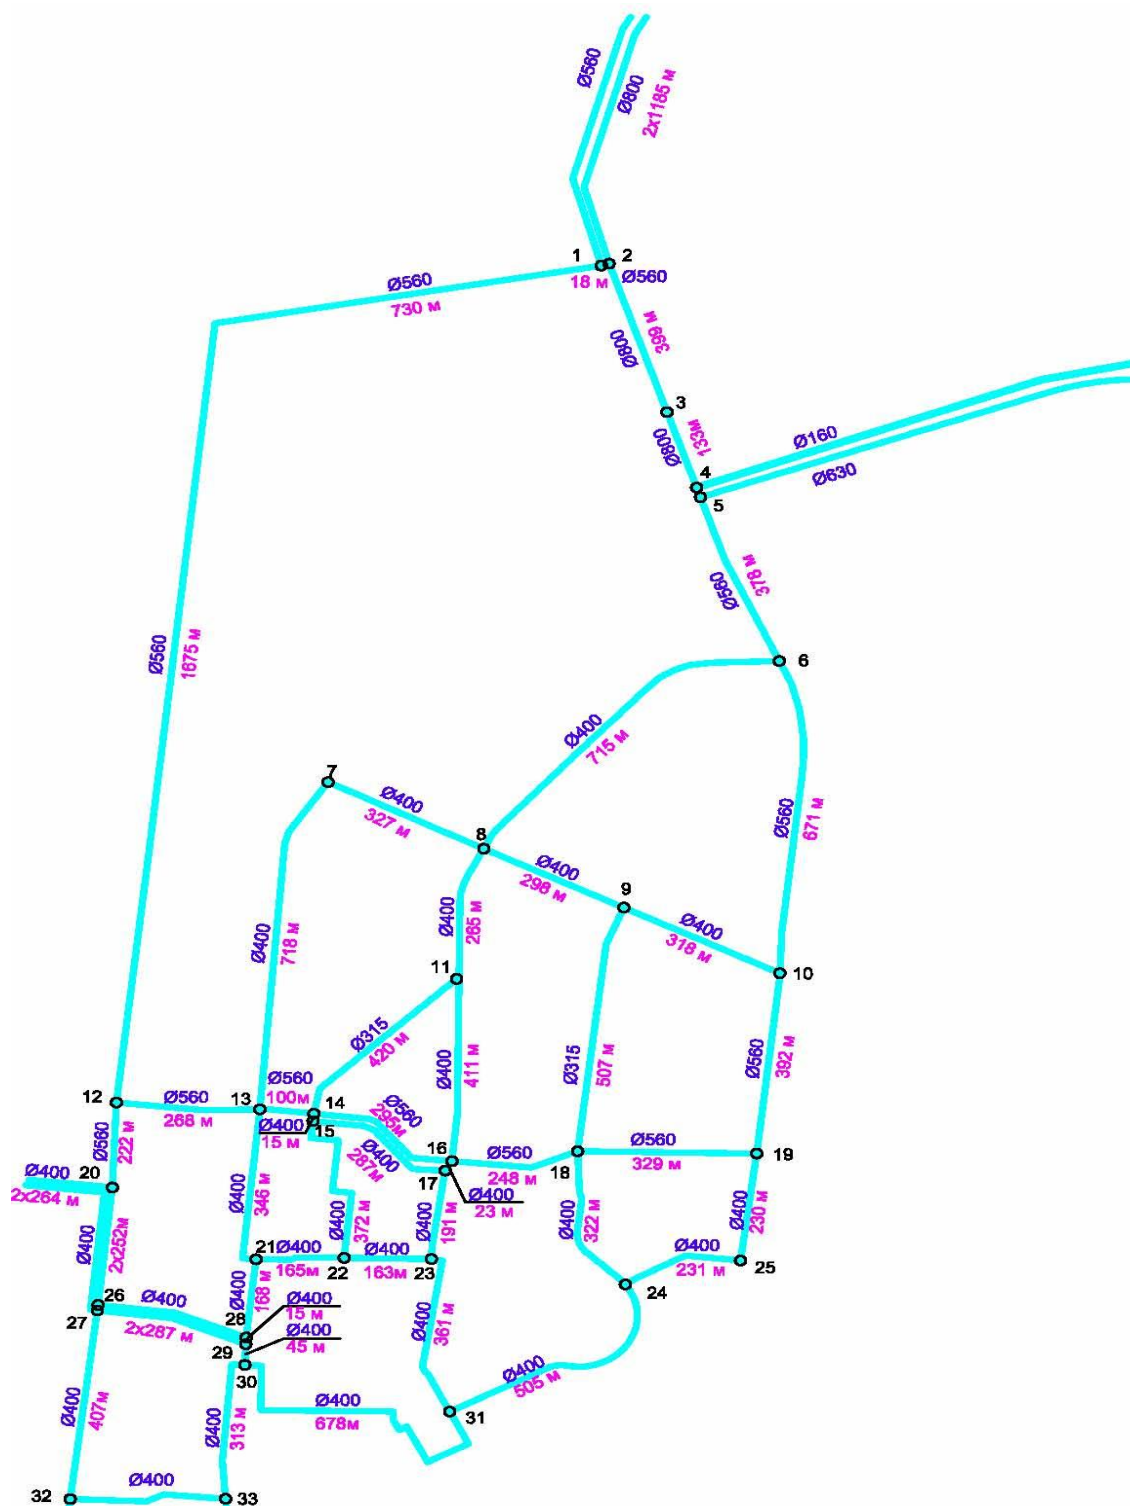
Расчётная схема водопроводной сети зоны "Кудрово" на 2020 г.
